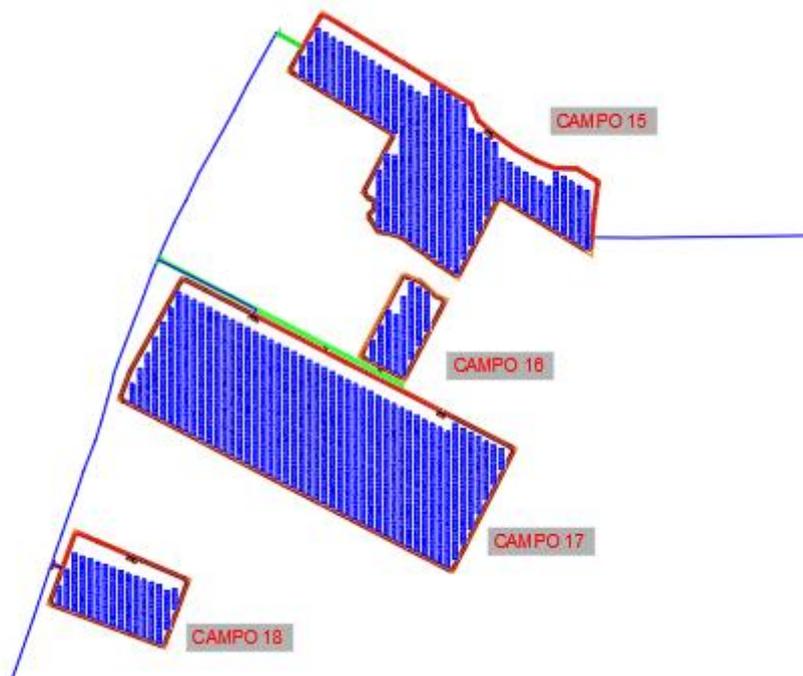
Schema layout dell'impianto – Vista Gruppo 2: da Campo 15 a Campo 18.
